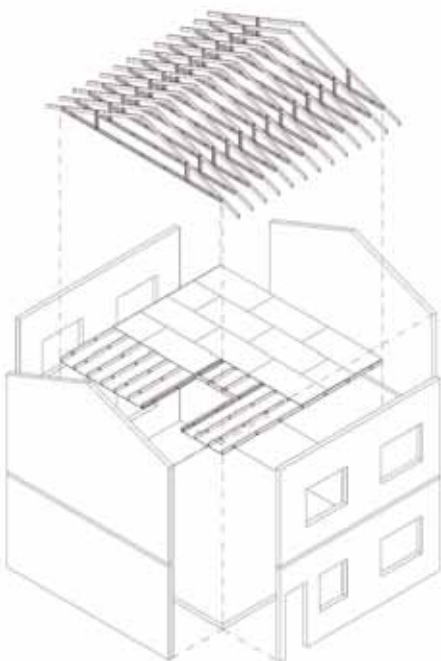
Esquema de construção tipo “platform” (Fonte: SCI)
